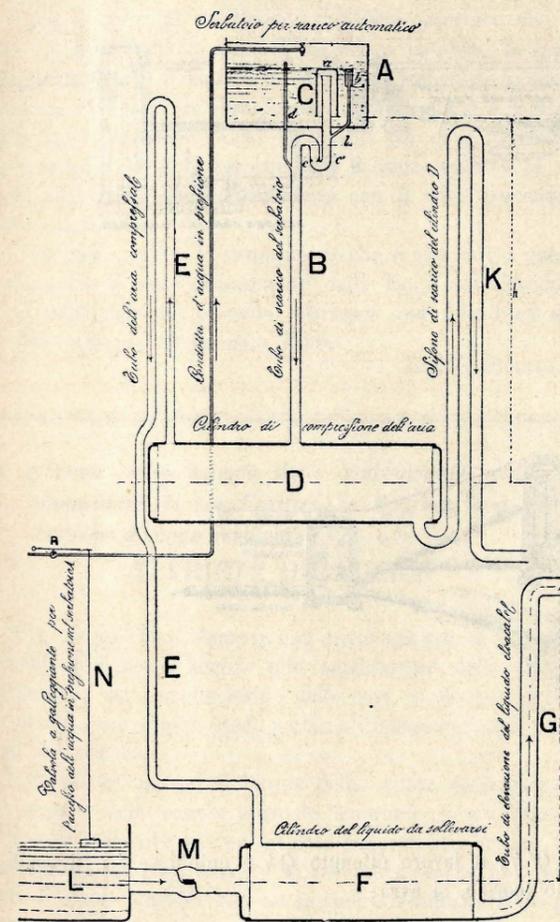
Disposizione schematica dell'apparecchio elevatore « Adams ».
